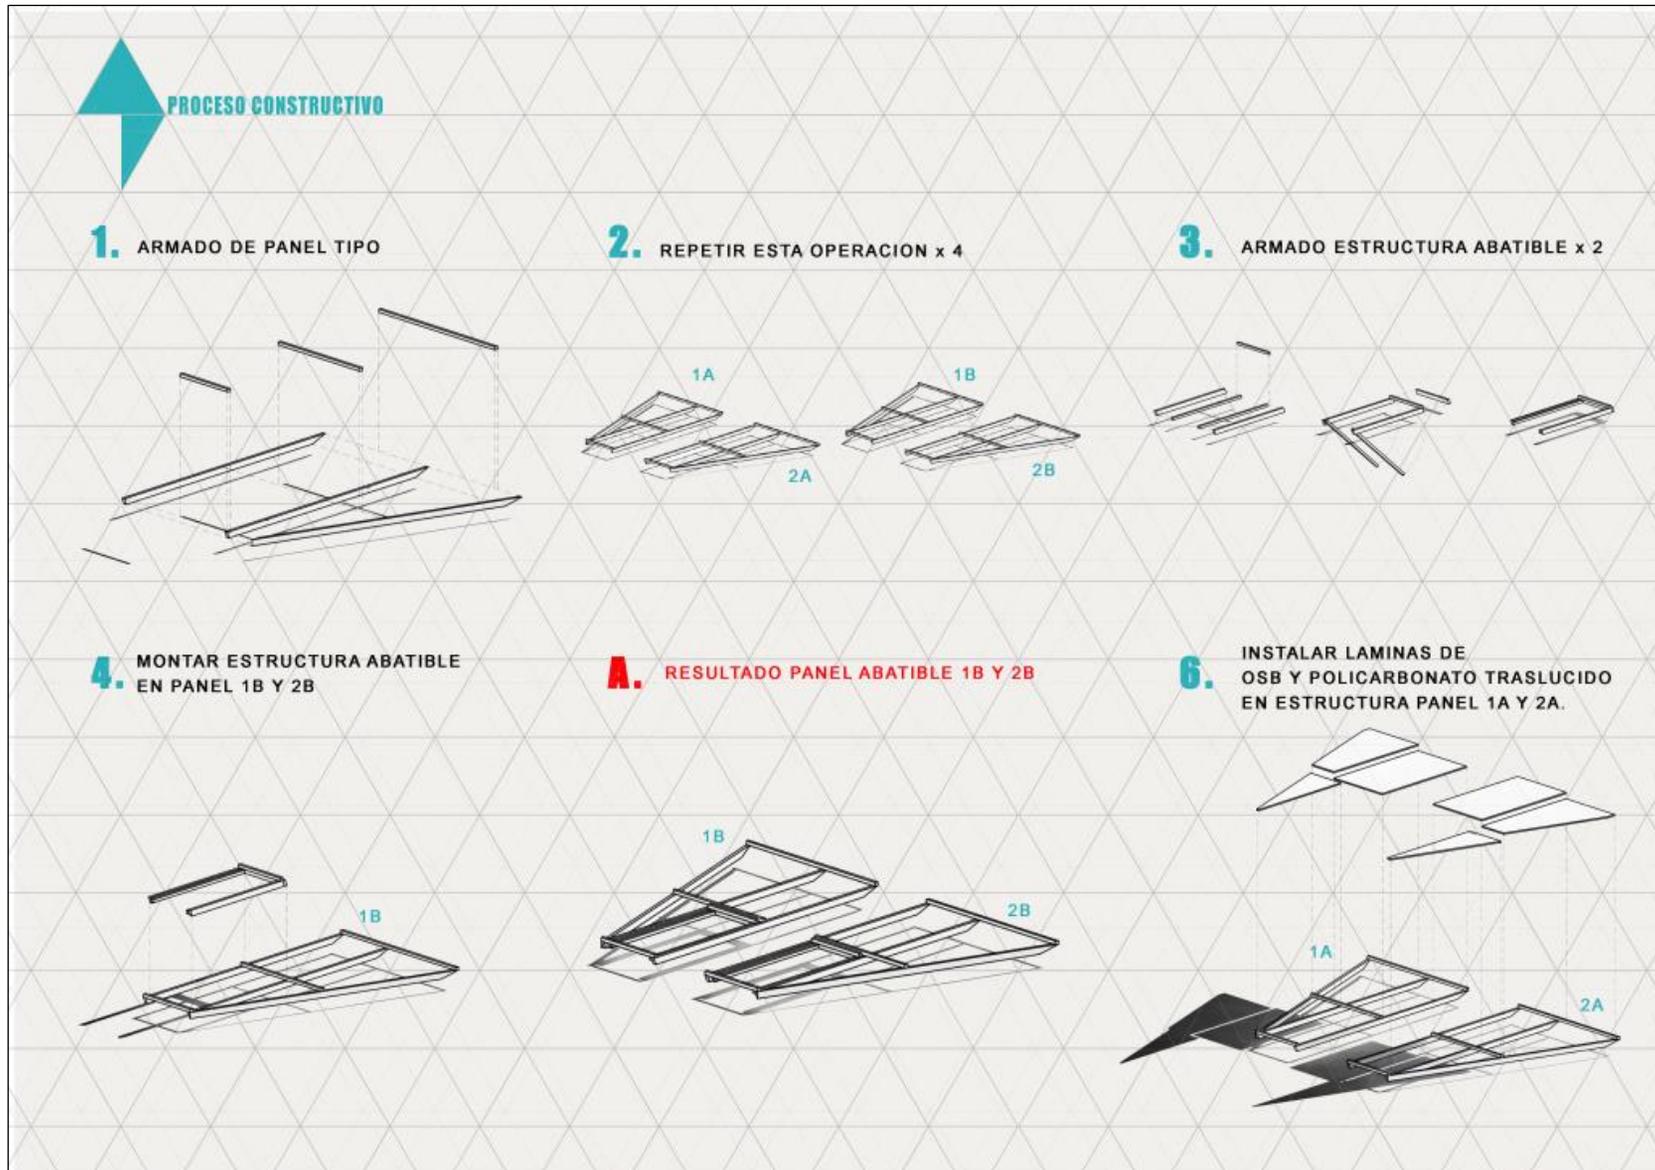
Proceso de armado de la vivienda emergente Casa Techo
